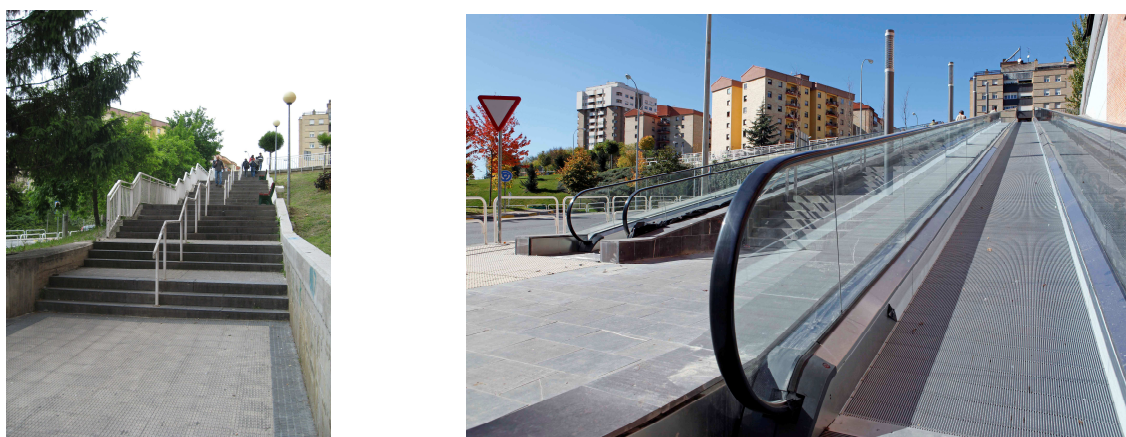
Conexión Azpilagaña e Iturrama antes y después de construir la rampa.
